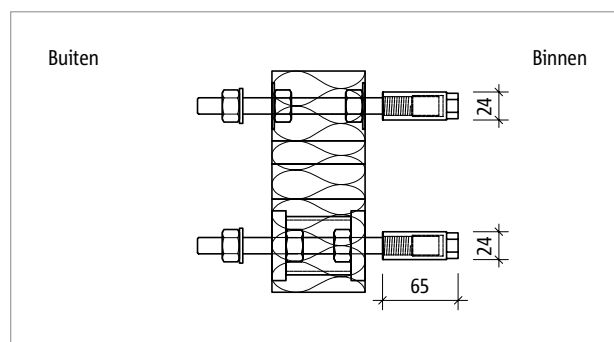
Schöck Isokorb® T type S met beschermende dopmoeren: Vrij uitragende staalconstructie; binnen chloridehoudende atmosfeer
